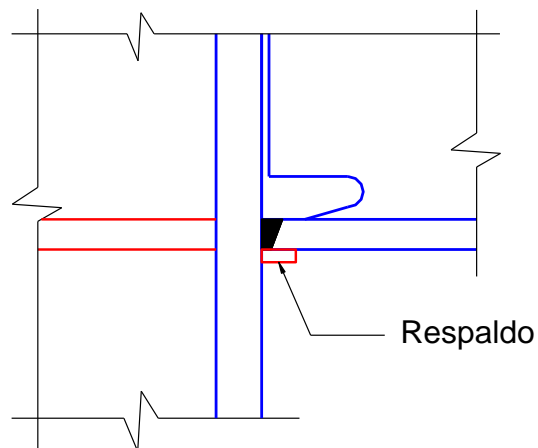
Detalle de la soldadura en el ala inferior de una viga.
